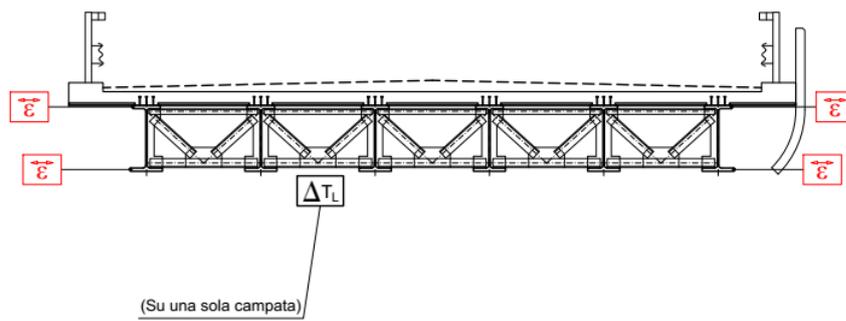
Ubicazione sensori su impalcato sezione a 6 travi (sezione trasversale viadotto Collestrada)
